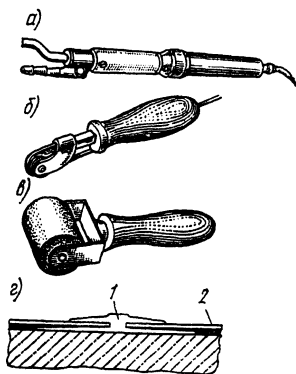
Инструменты и приспособления для сварки линолеума горячим воздухом
